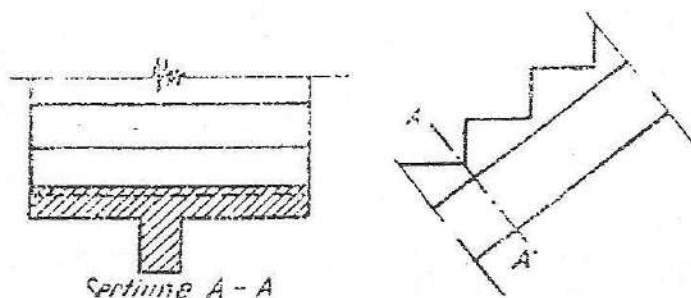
Scară de beton armat rezemată pe o singură grindă.
